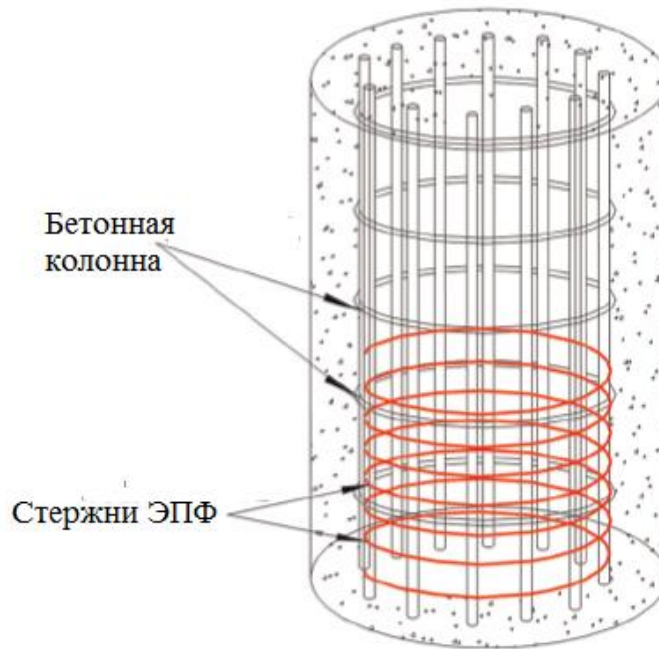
Опытные испытания железобетонной колонны, армированной стержнями с памятью, Q. Чен и Б. Андравес, Университет Иллинойса в Урбана-Шампейн, США [156]
